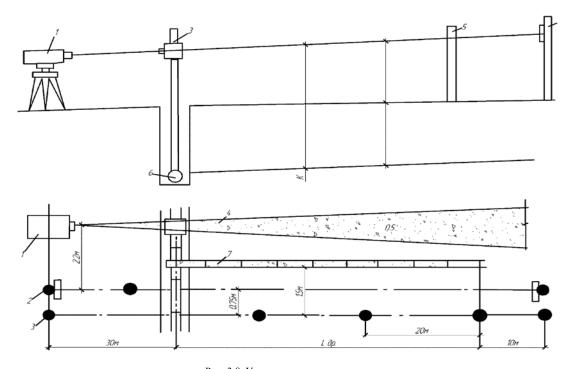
Установка светоизлучателя: – светоизлучатель; 2 – курсовая веха; 3 – фоторейка; 4 – пучок лазерного излучения; 5 – веха; 6 – коллектор; 7 – дрена; 8 – веха выносной оси
